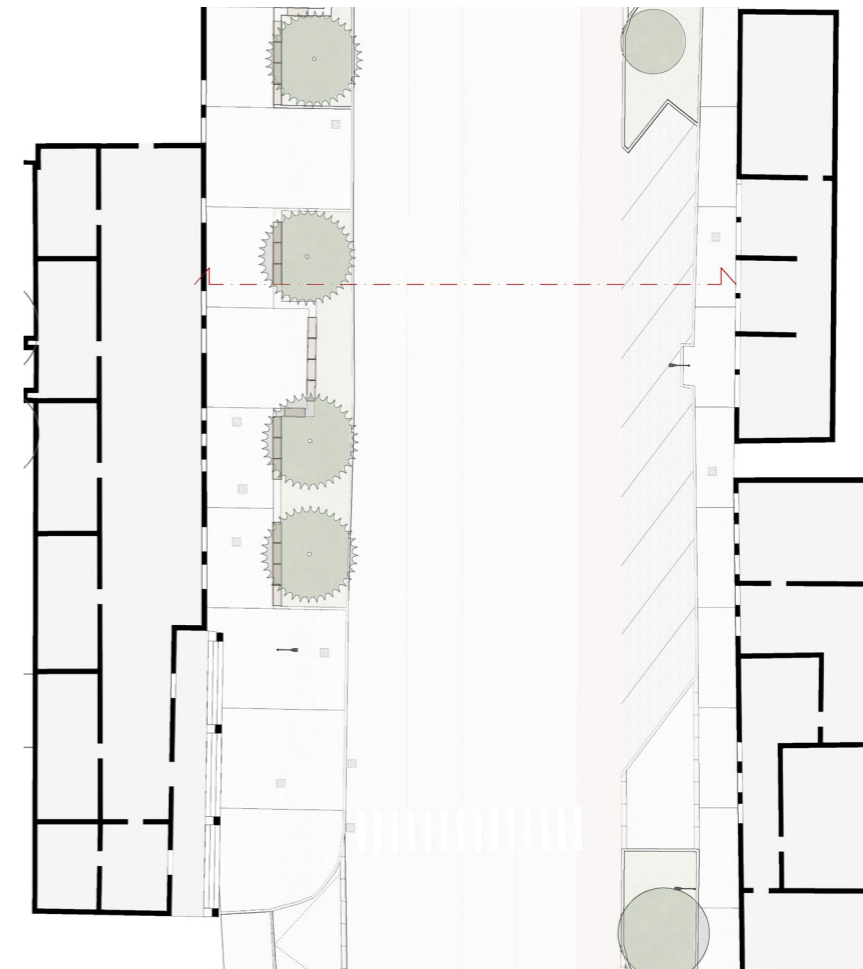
Sezione stradale di progetto davanti Casa Jannacci
